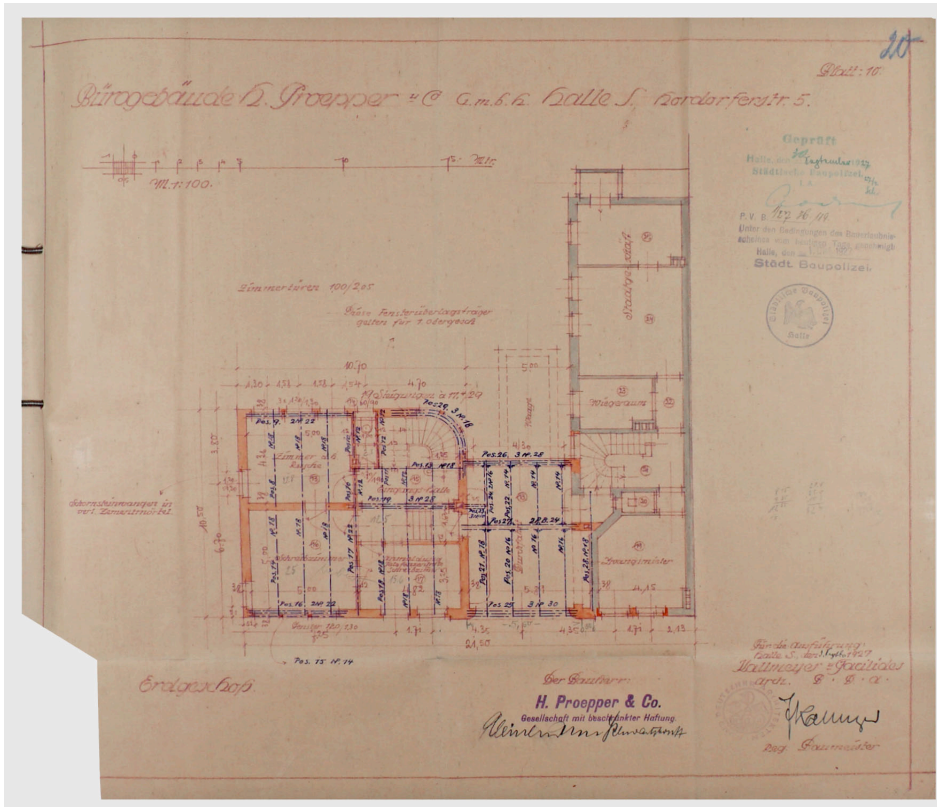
Bürohaus H. Proepper & Co. in der Hordorfer Straße 5 in Halle, Grundriss Erdgeschoss, datiert 5. September 1927.
